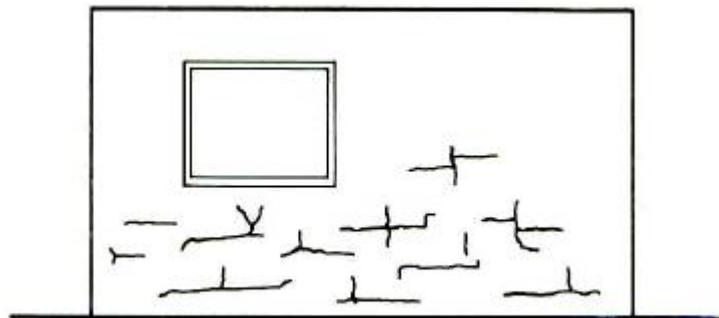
Fissuras horizontais provocadas pela expansão da argamassa de assentamento
